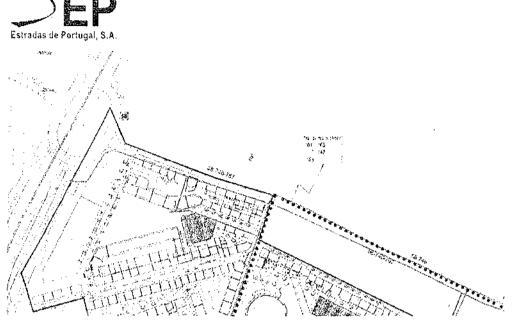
Extrato da Planta de Estacionamento e Circulação (Peça Desenhada n.º 18)
